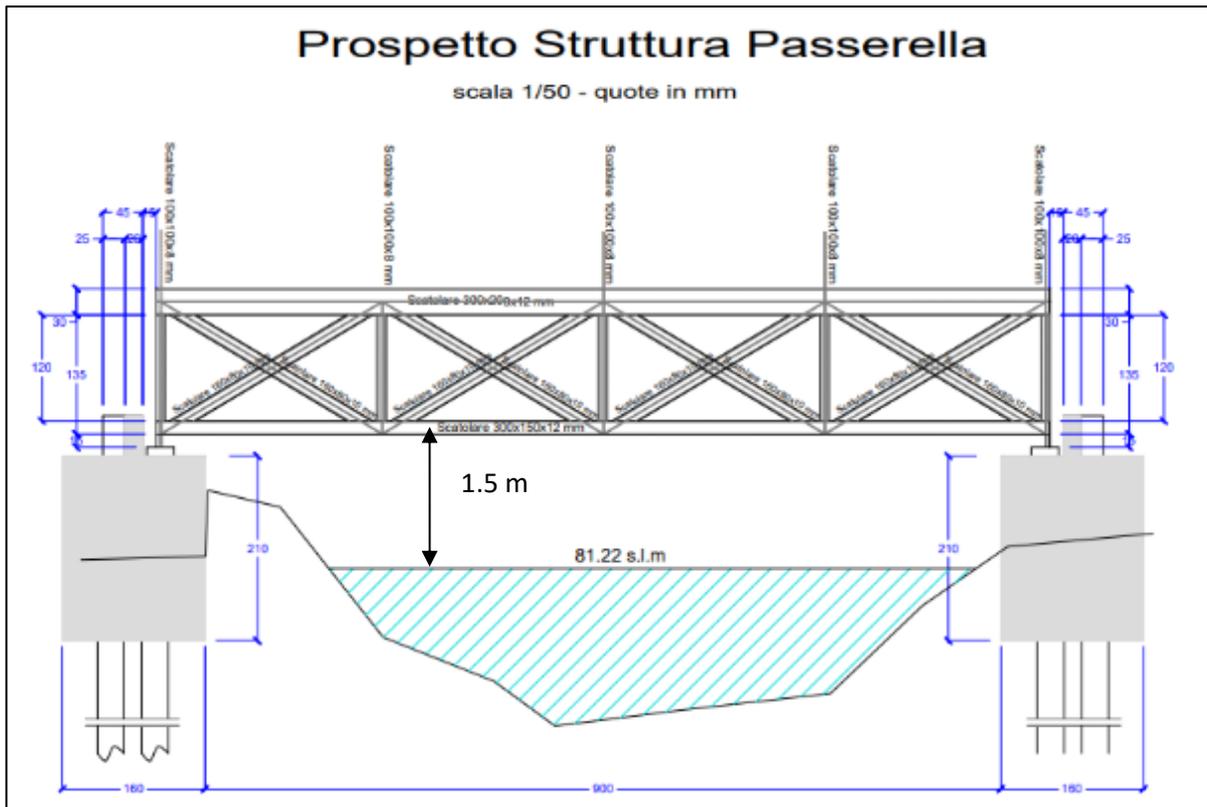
Schema strutturale attraversamento Ciclovía Sole sul T. Settola
